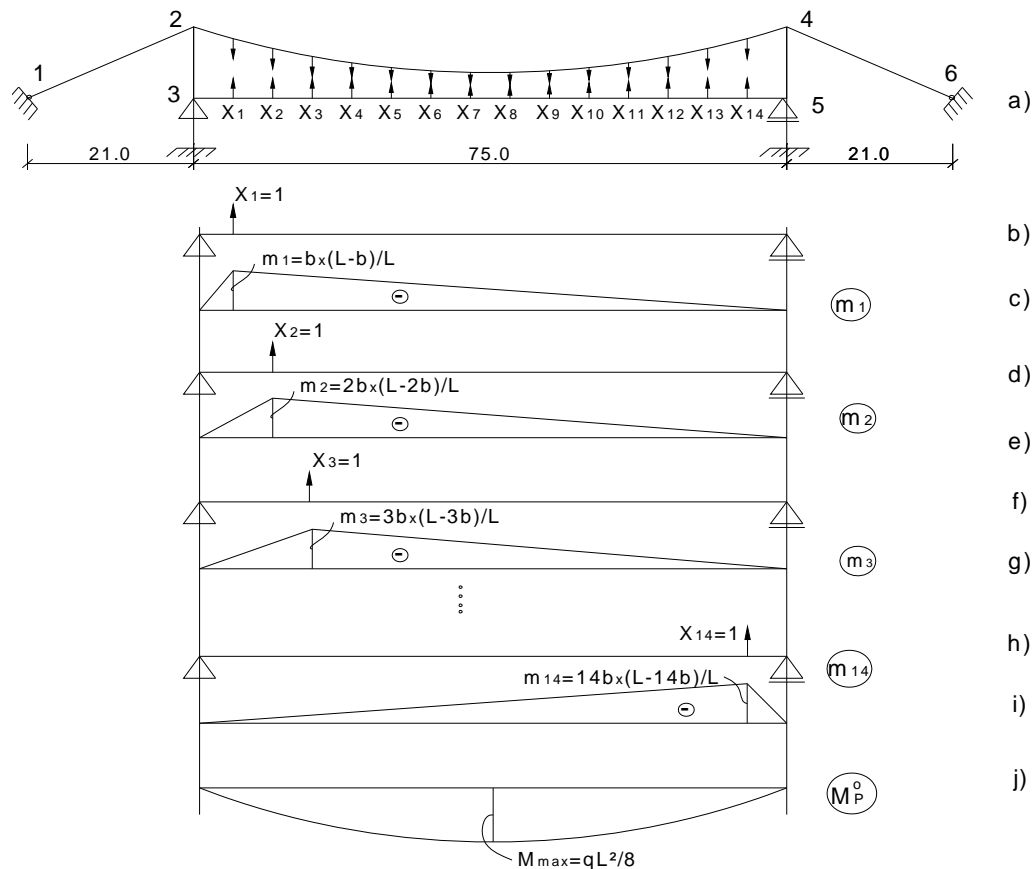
Structura de bază pentru traversarea cu cabluri parabolice
